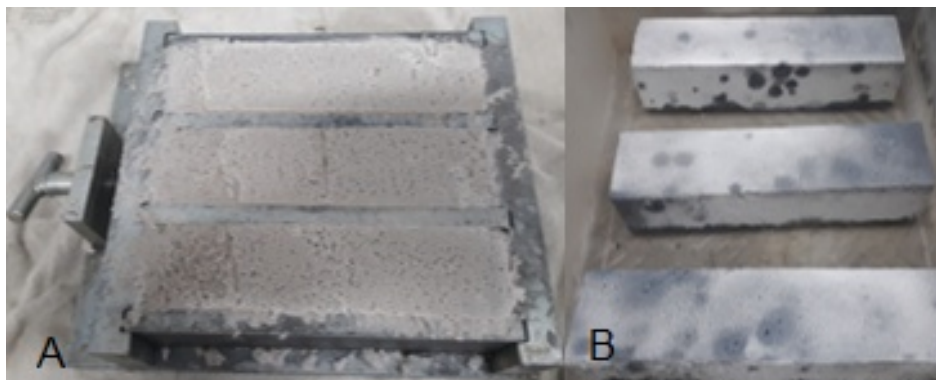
A) Moldagem de corpos de prova para ensaio de resistência mecânica. B) Corpos de prova desmoldados.
